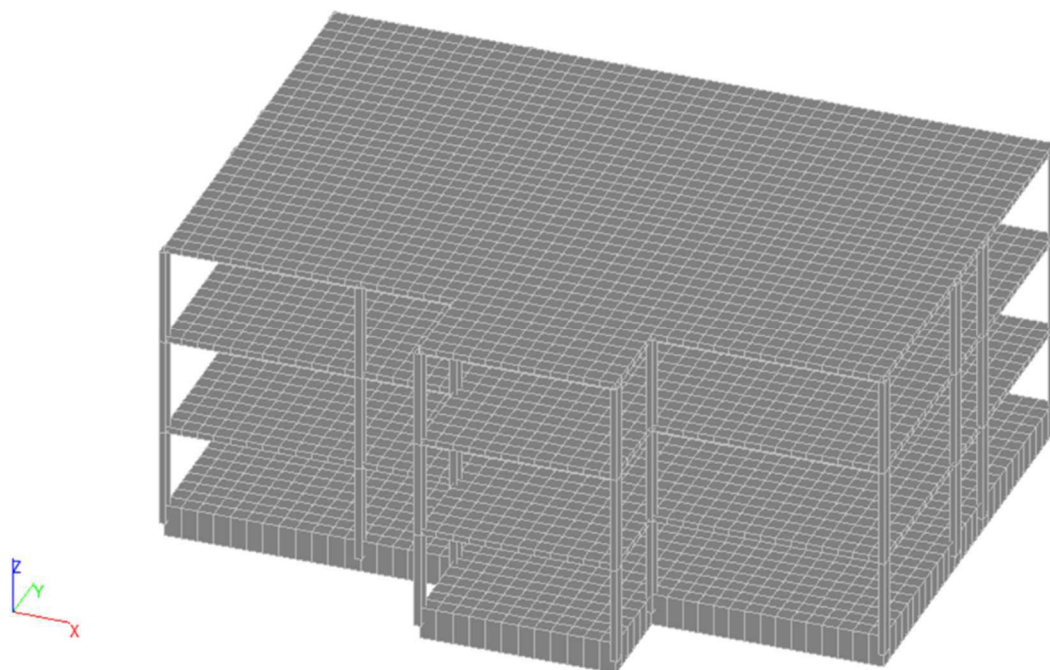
Геометрическая схема междуэтажного перекрытия в режиме презентационной графики
